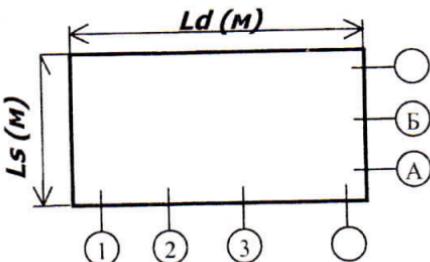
Схема этажа здания по наружному обмеру с осевой разбивкой
